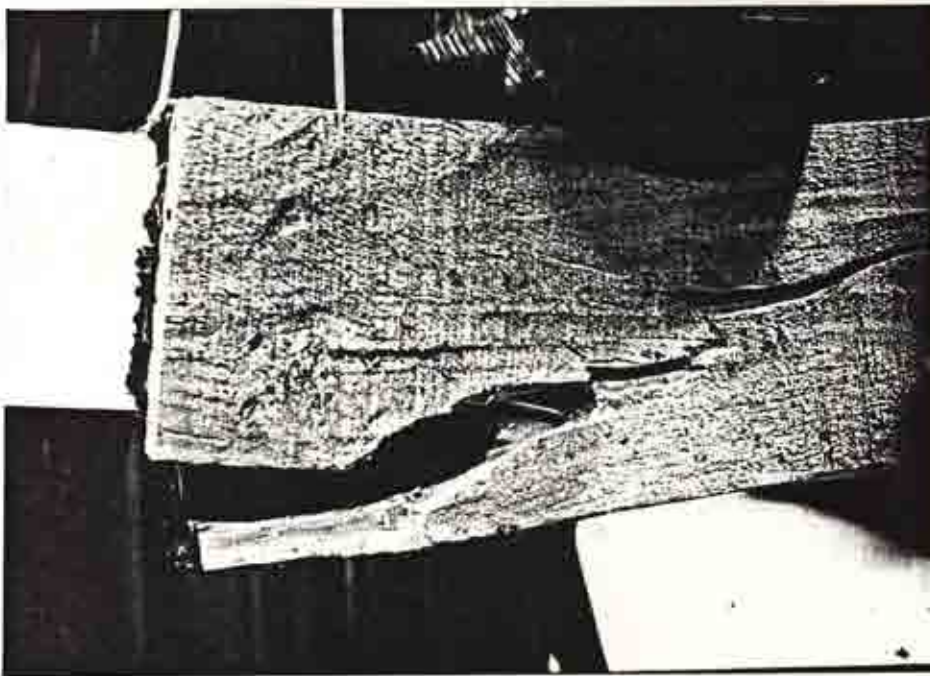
Detalle de la rotura de una viga con placa en el apoyo ensayada a flexión.
